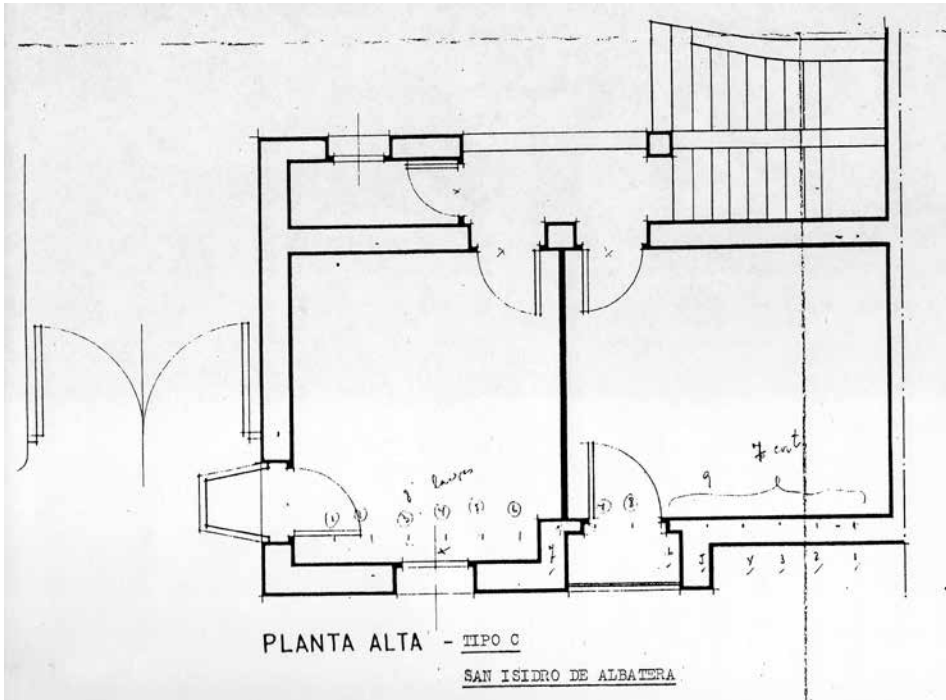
San Isidro, planta vivienda, tipo C, planta alta.
